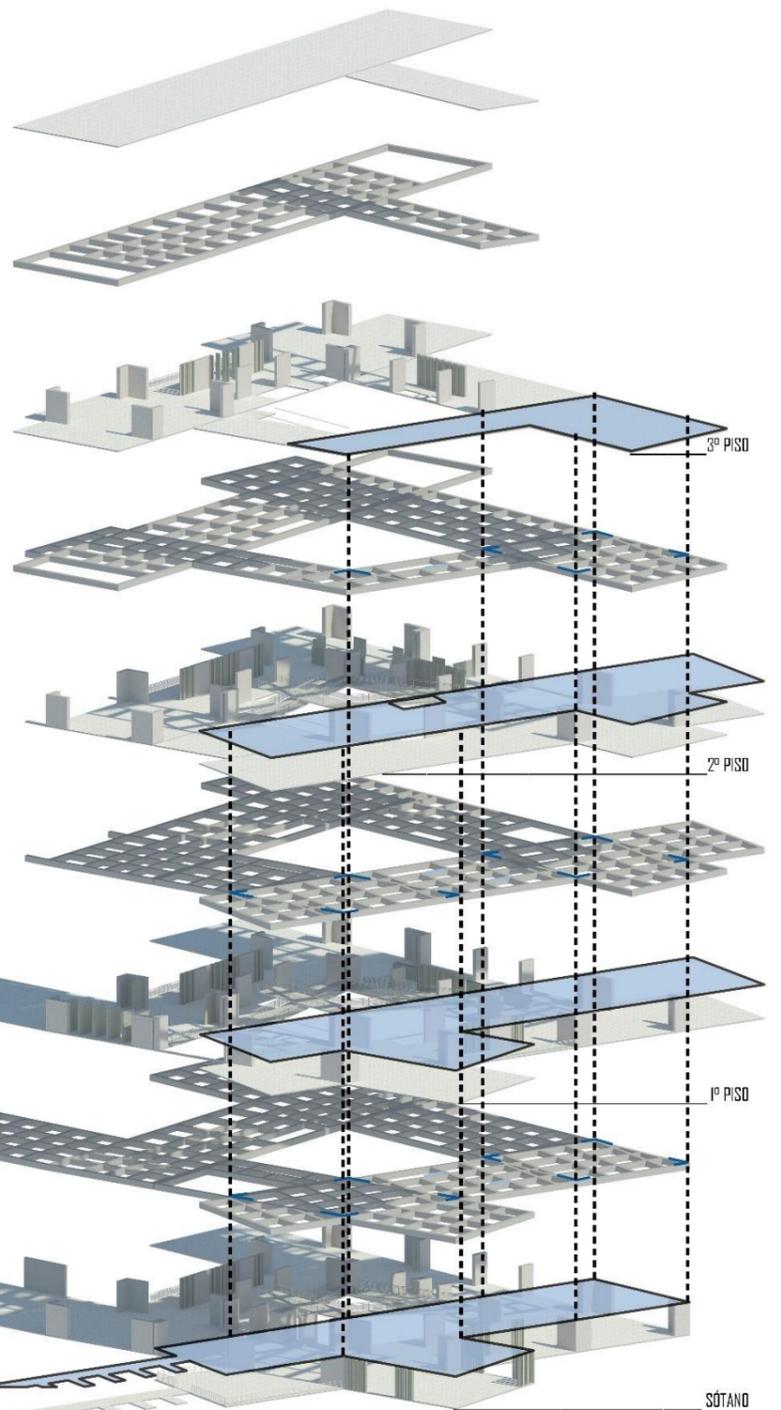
Estructura del módulo 3 con columnas tipo I y L
